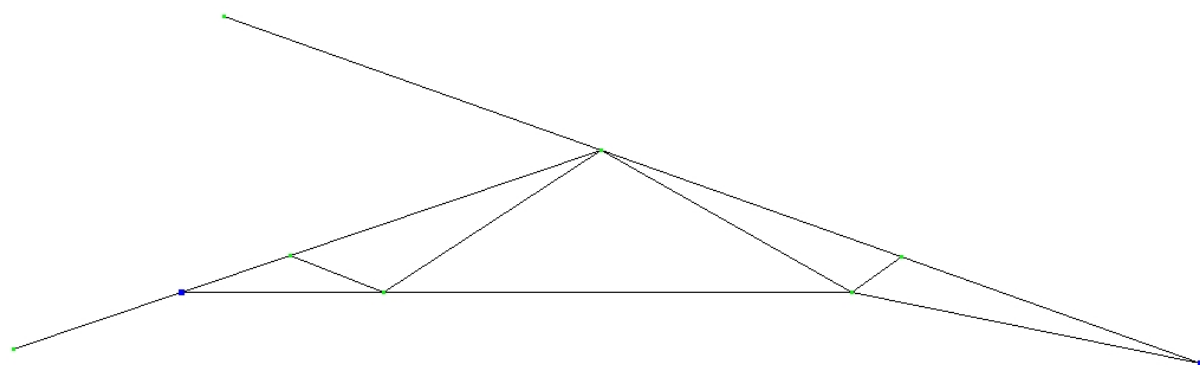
Розрахункова модель ферми з клеєного бруса з металевою вставкою нижнього поясу
